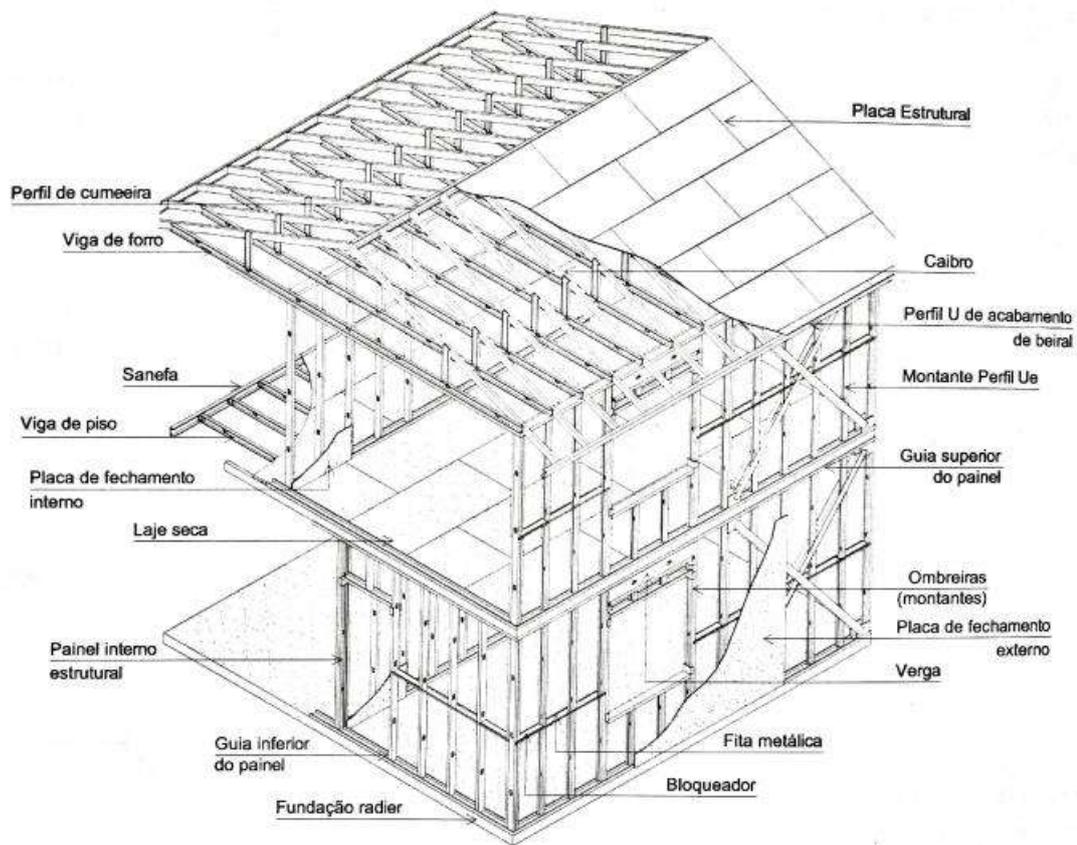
Etapa construtiva do sistema *Light Steel Framing*.
